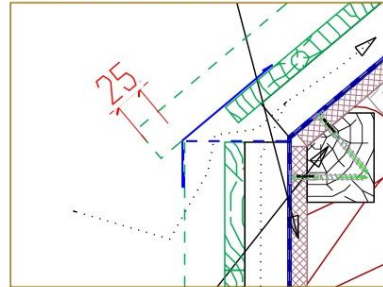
DETAILS BUREAU D'ETUDE STRUCTURE BOIS
